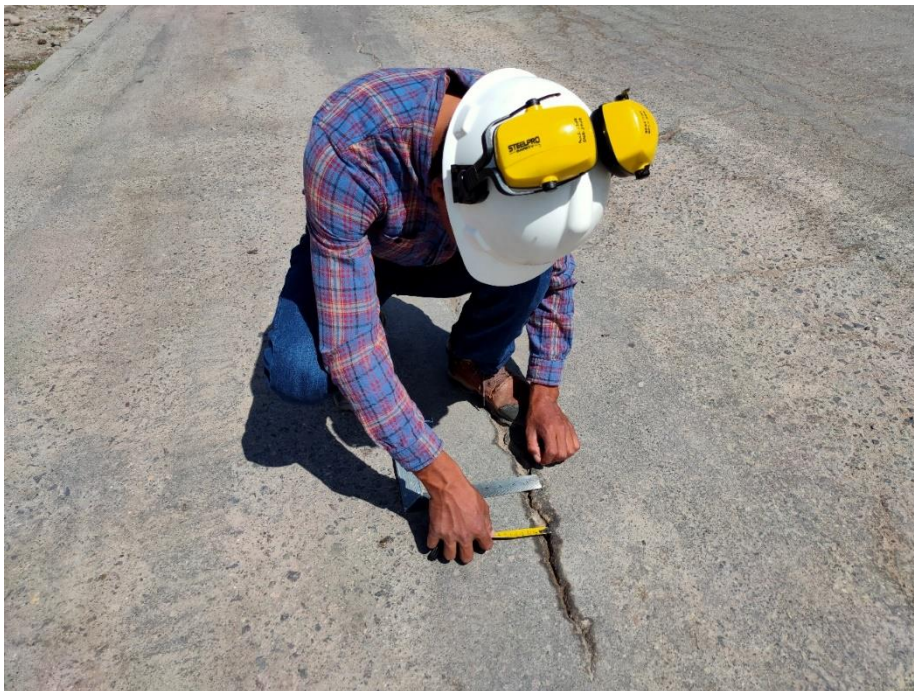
y 17: Se observa la falla tipo fisura parabólica de baja severidad, y una grieta longitudinal de alta severidad
